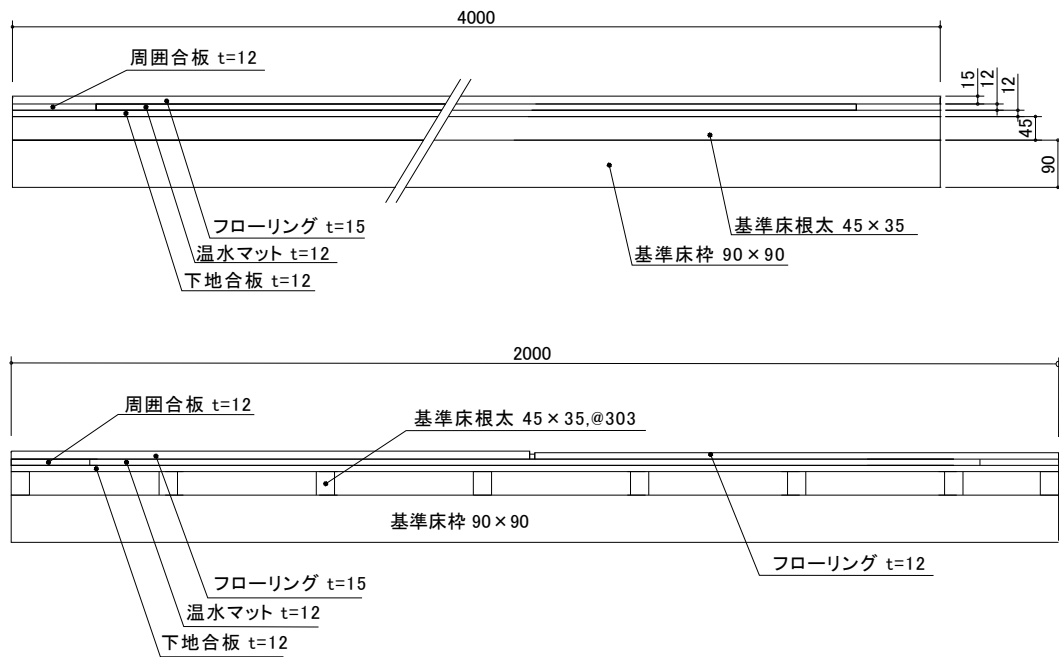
試験体図（試験体断面図、施工時に確認） 単位：mm
